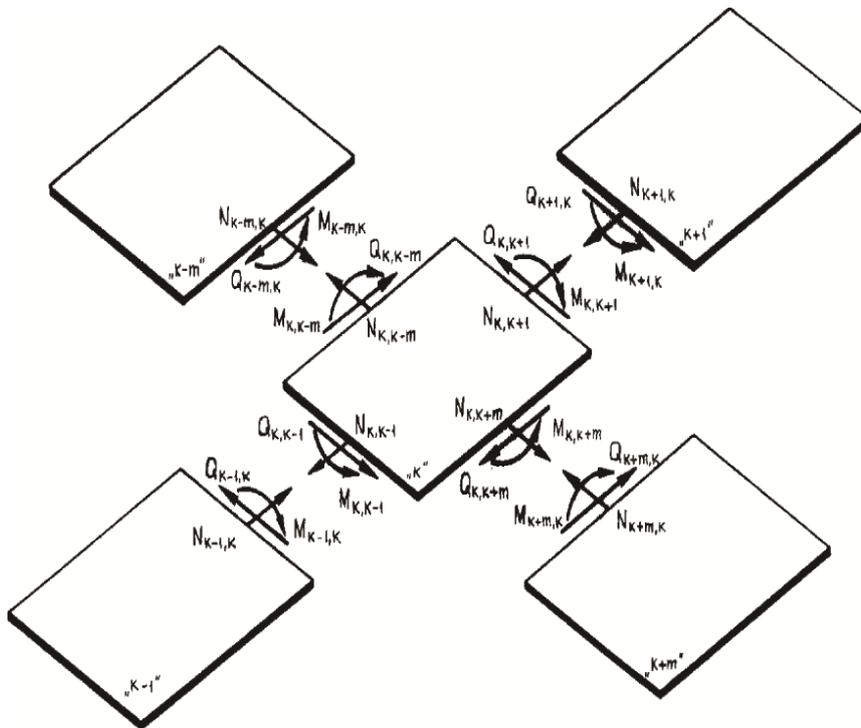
Изгибаемая железобетонная конструкция, внутренние силы плосконапряженного состояния конструкций
